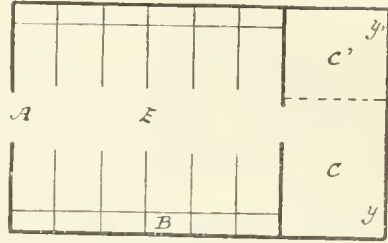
Plan d'une écurie à deux rangs tête au mur.
